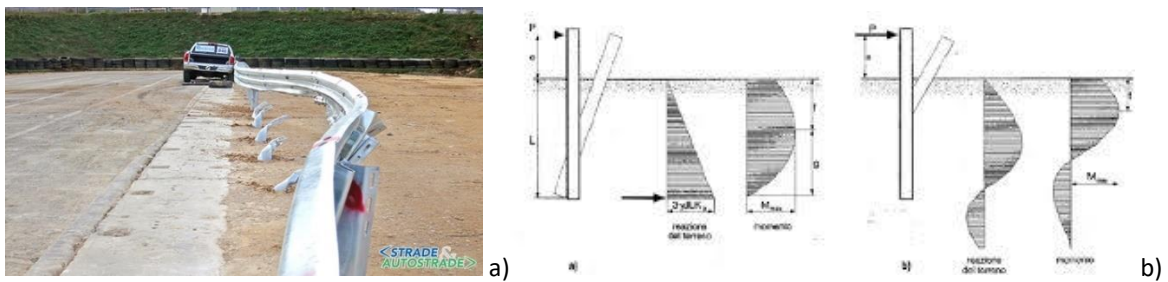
Barriere infisse nel terreno: a) crash-test b) tipi di interazione con il terreno
